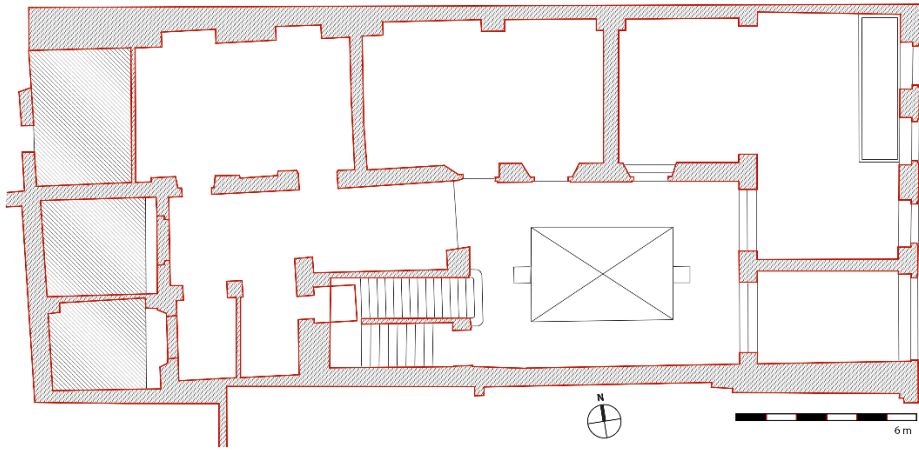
Planta del primer nivel o planta baja del edificio. Redibujado íntegramente y modificado por el autor del original proporcionado por cortesía del Ingeniero Teodoro Sánchez.
